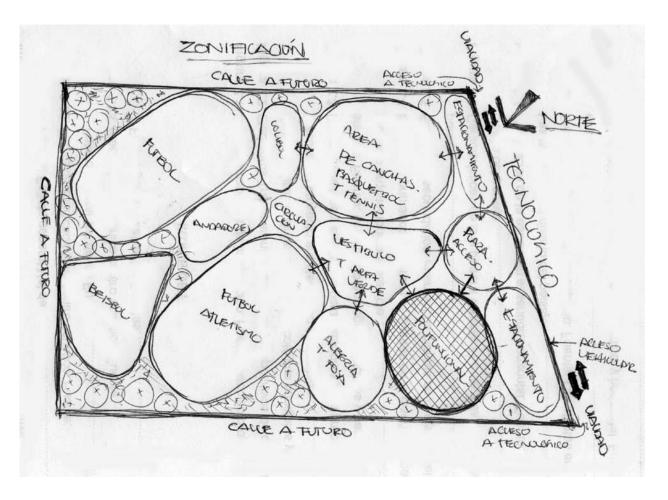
Zonificación. FUENTE: Archivo propio.
